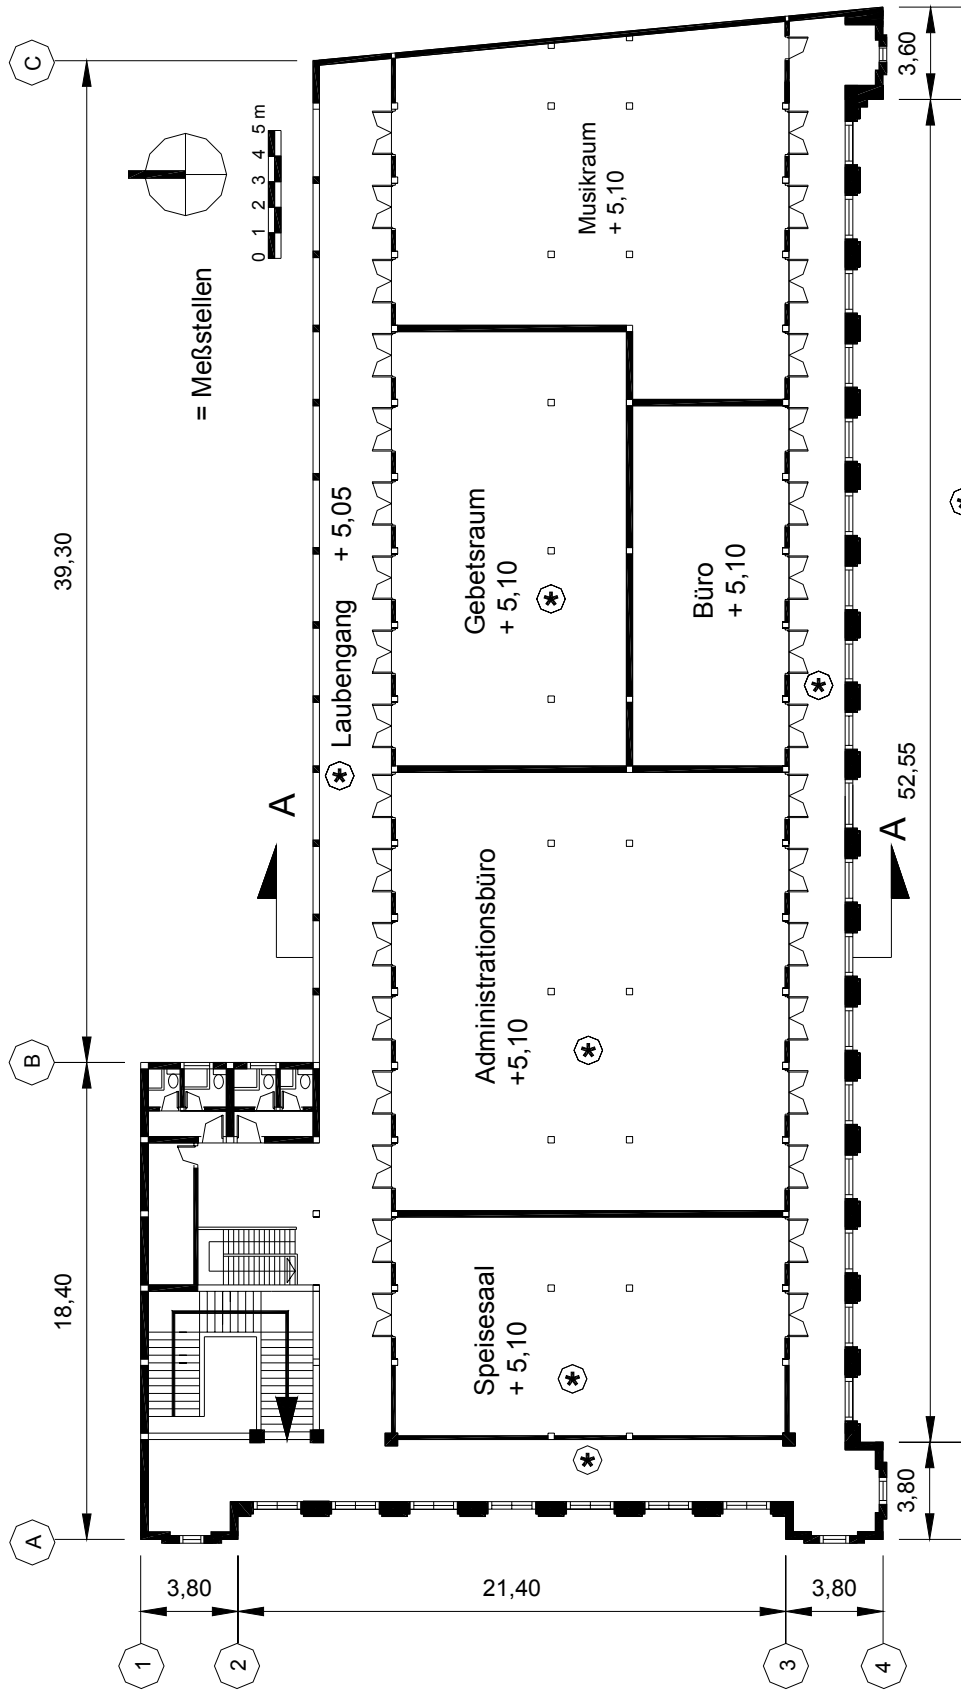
Grundriss 1. Obergeschoss von Gebäude B4
